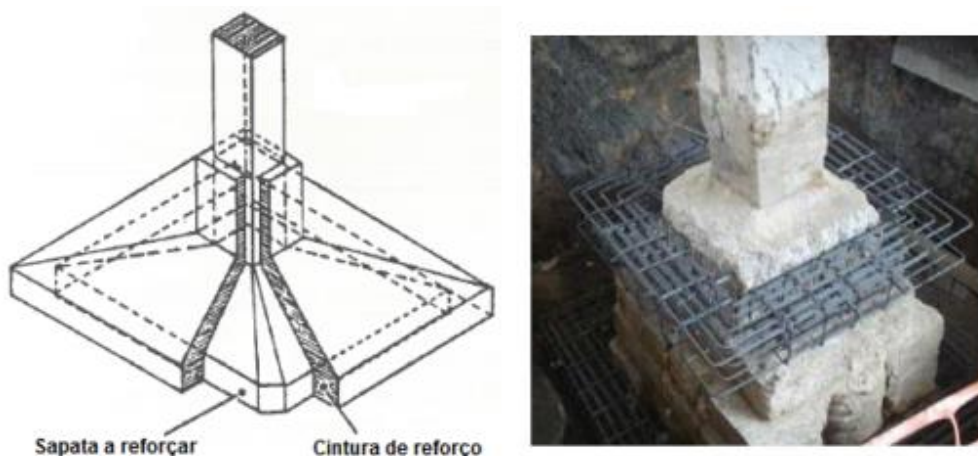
Exemplo de alargamento de sapatas isoladas (Reabilita & Funda, 2014)
